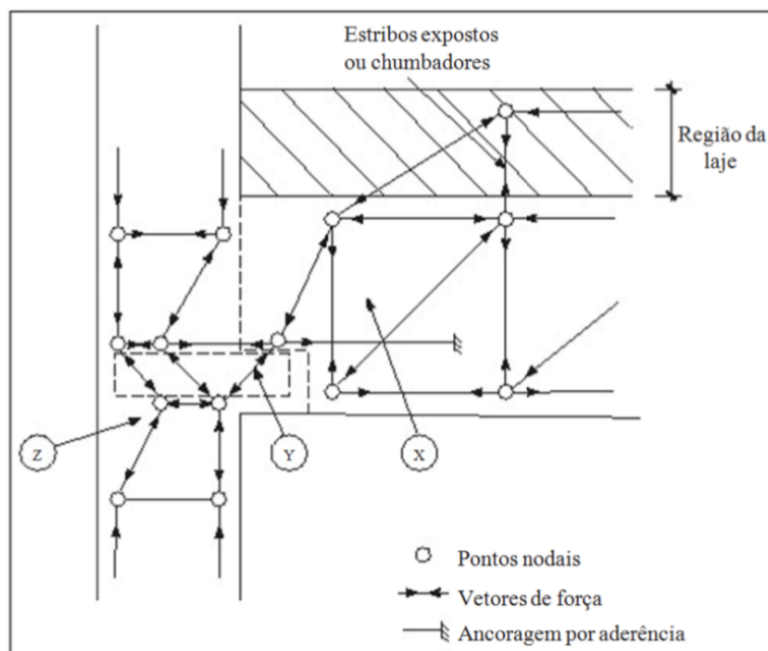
Trajetória das forças em uma ligação viga-pilar durante a montagem.
